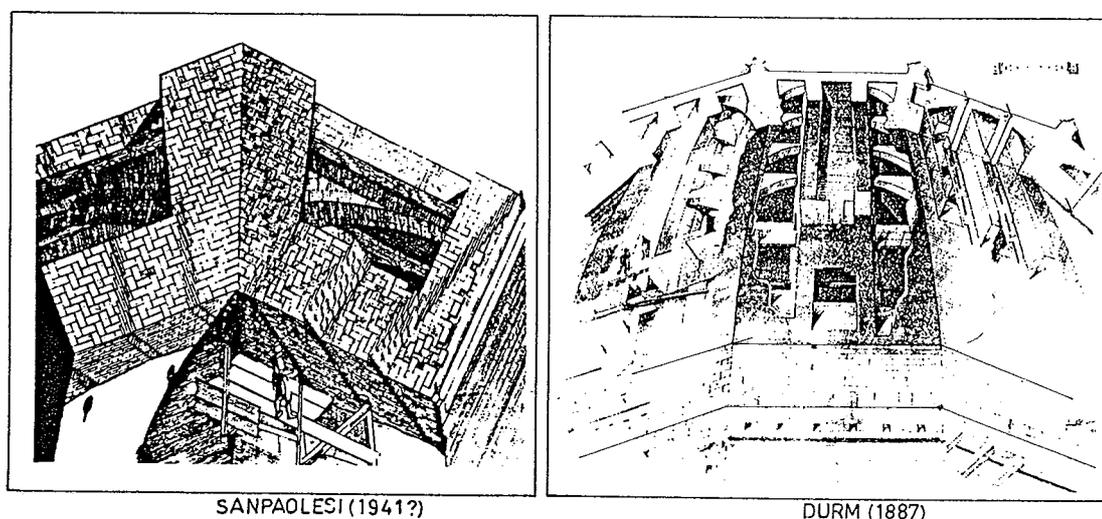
Método constructivo de Brunelleschi para Santa Maria del Fiore
